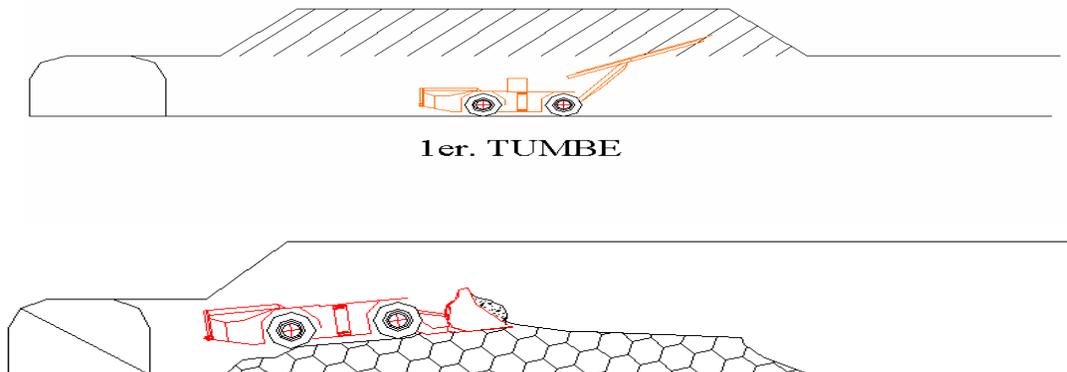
Primer etapa de tumble vertical y aplanillado de mineral tumbado
